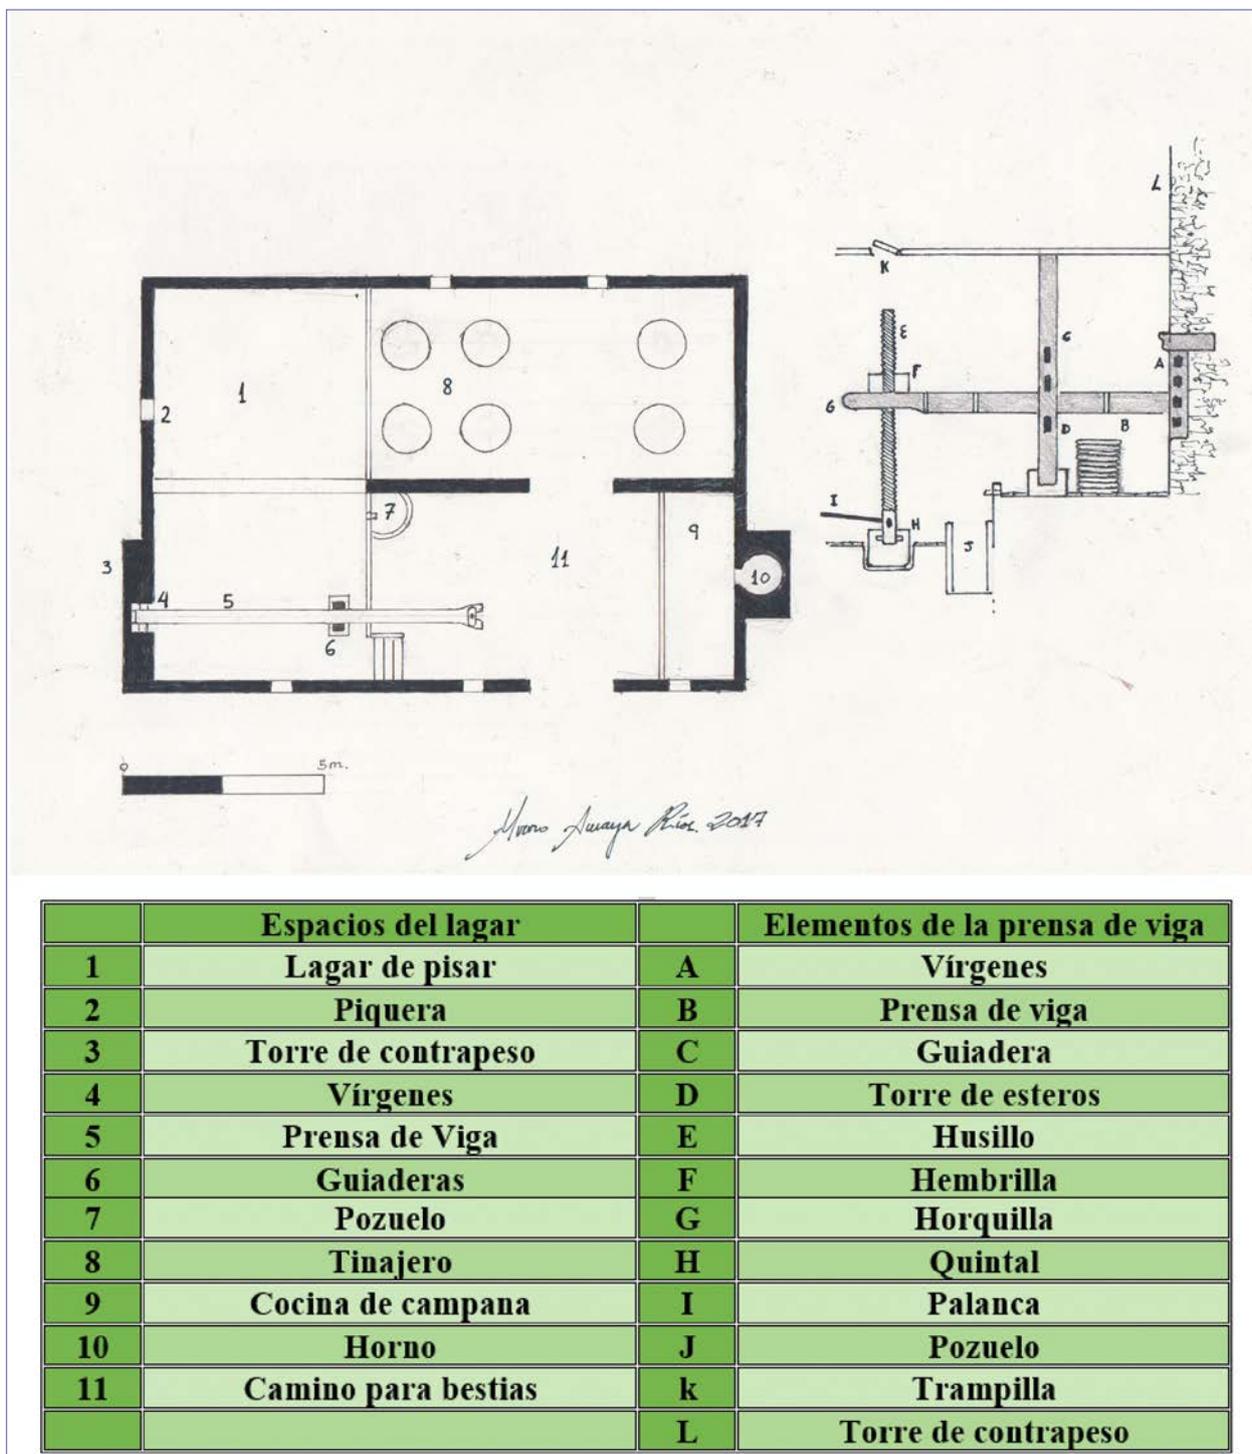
Planta básica de un lagar y partes de la prensa de viga y husillo.
